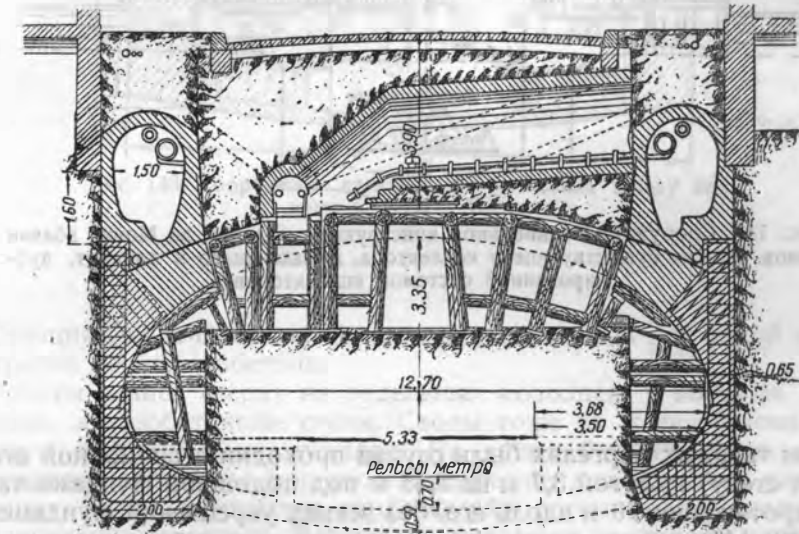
Сооружение станции „Рю де Кример“ между домами, при железобетонных стенах.
